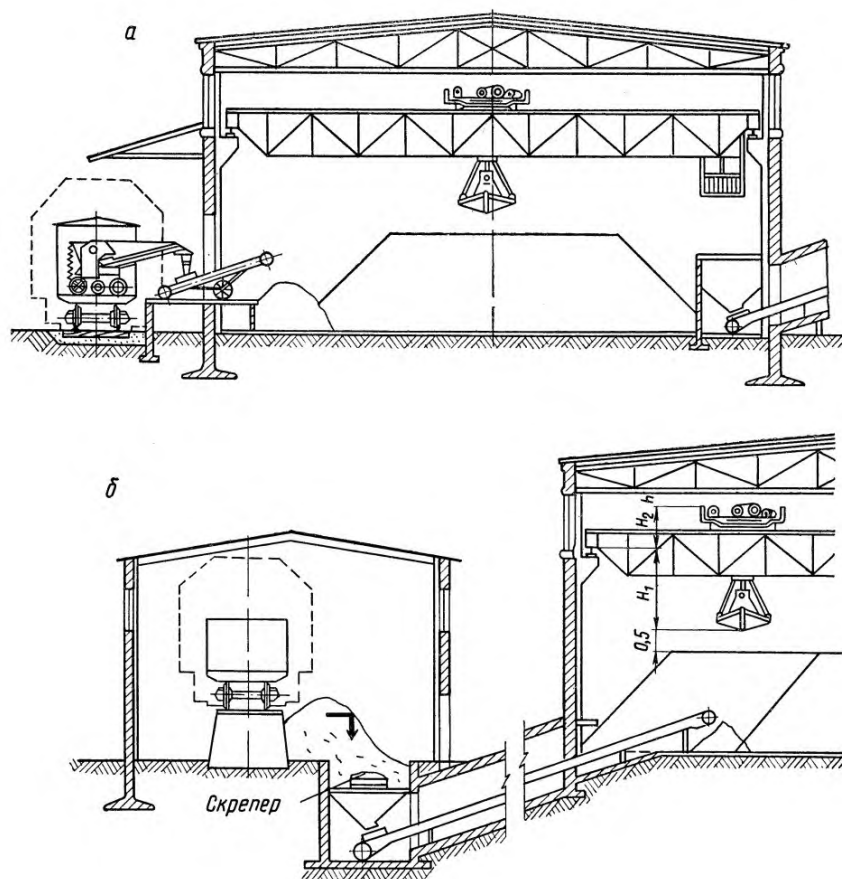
Варианты складов, оборудованных мостовыми кранами с грейфером для приема насыпных грузов: *а* – из крытых вагонов; *б* – из полувагонов
